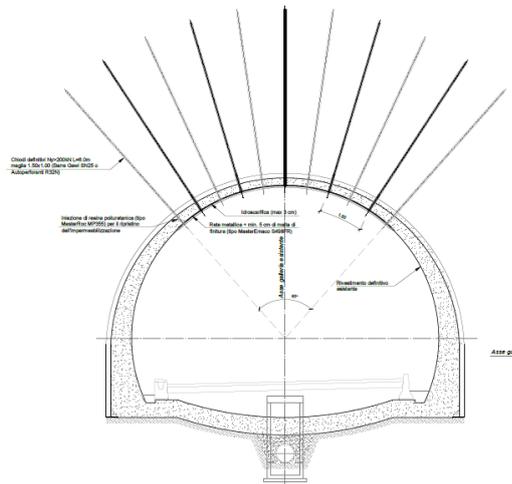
Galleria Guinza – Intervento Tipo B – Sezione corrente
